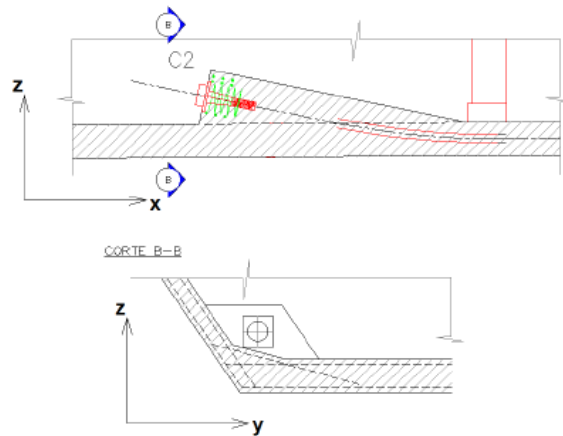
Seção transversal em trecho de engrossamento de almas e laje inferior com tirantes
